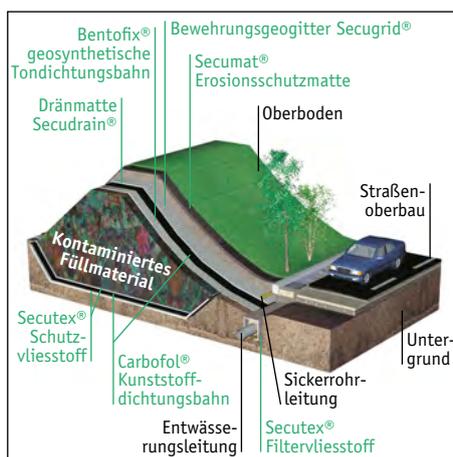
Dichtung eines kontaminierten Lärmschutzwalles
